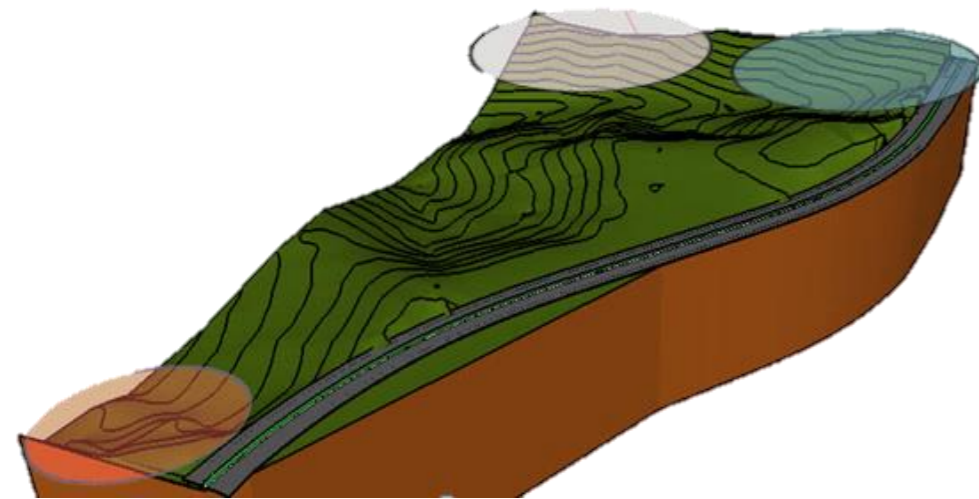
trois pôles du site en vue 3D ⁽⁶⁾
